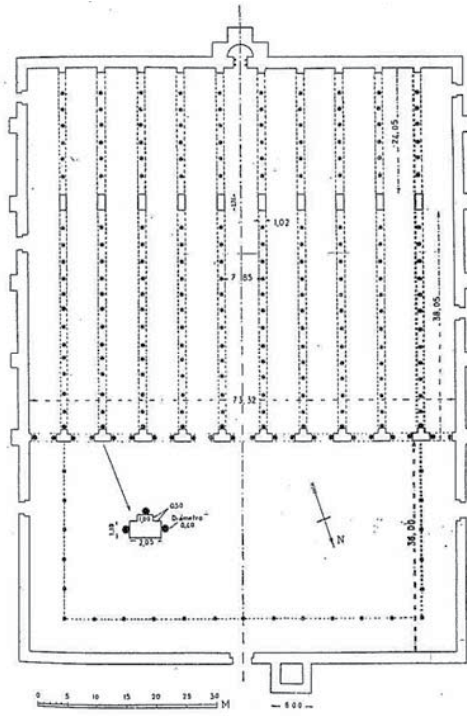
جامع القصبة بإشبيلية، مسقط أفقي، عن:
